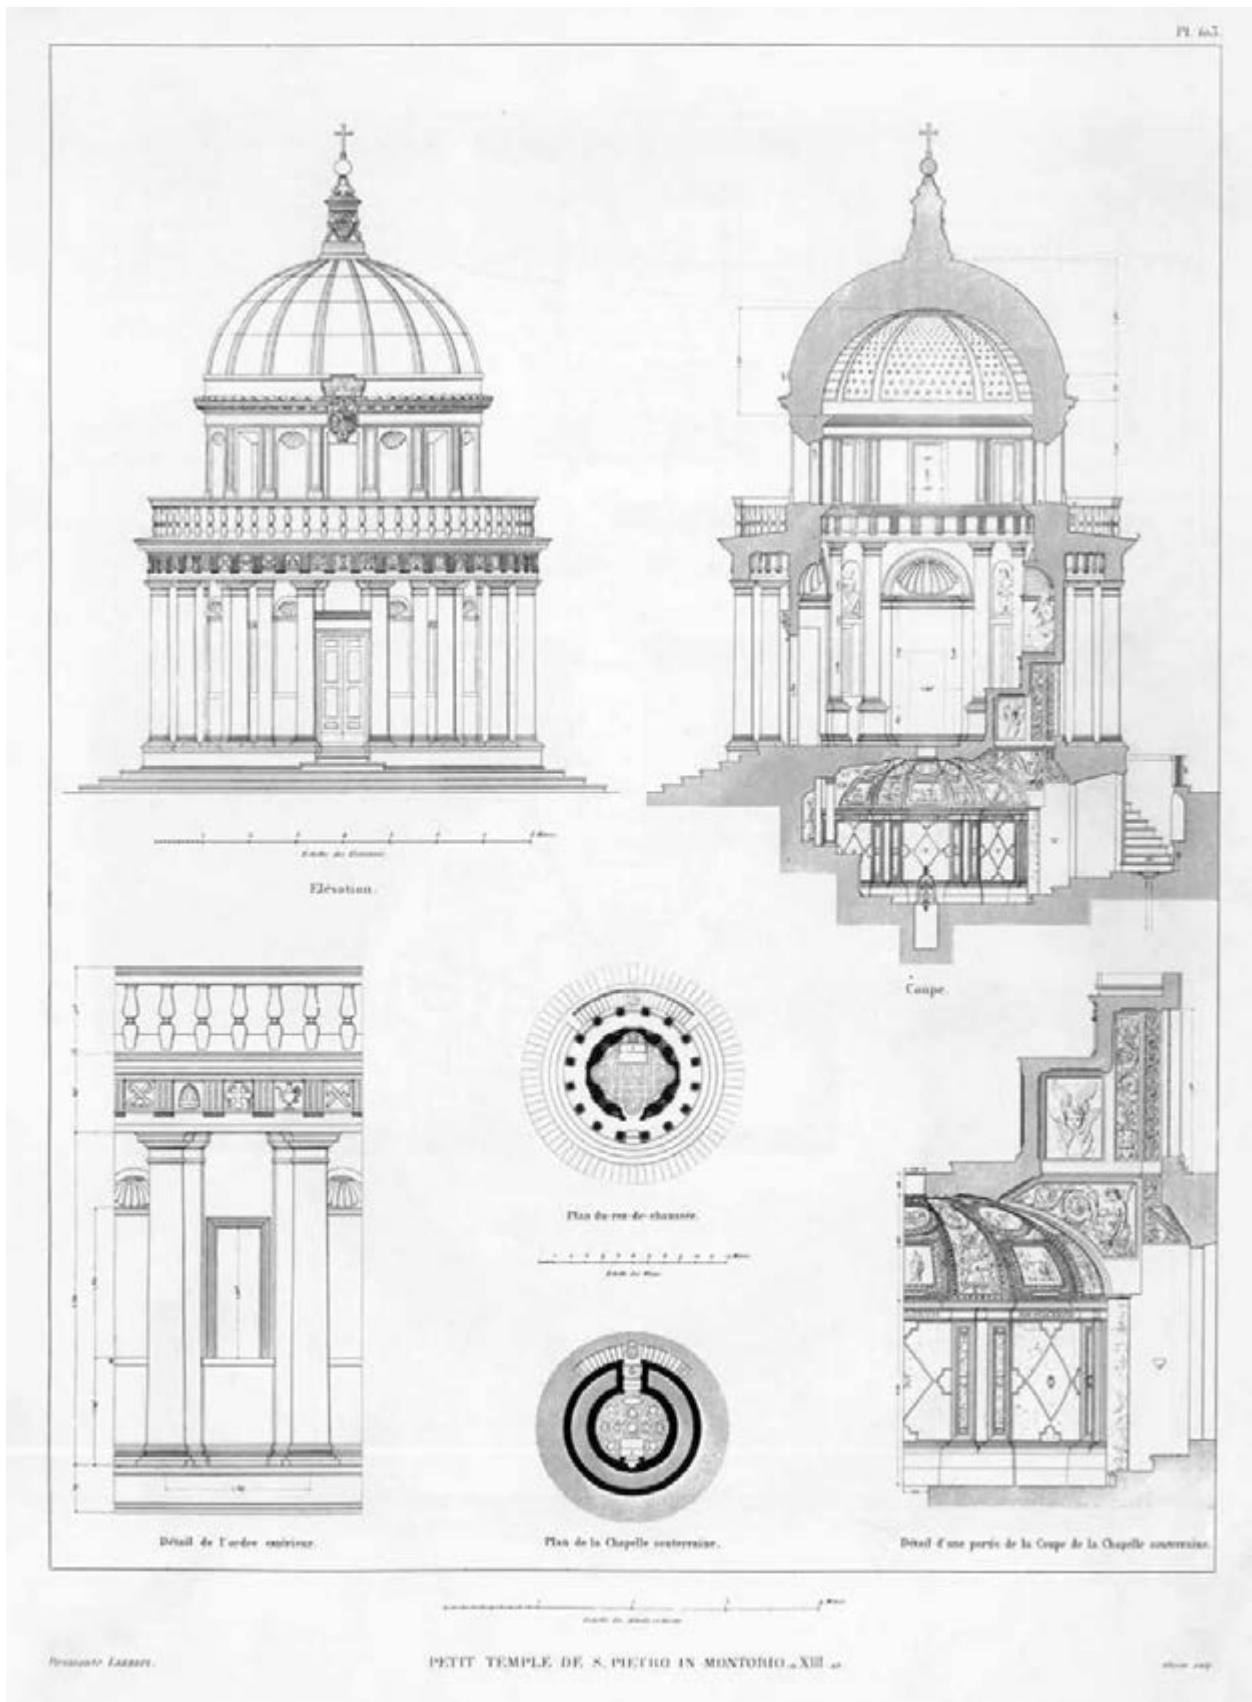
Paul Letarouilly, piante, prospetto, sezione e particolari del Tempietto (LETAROUILLY 1840, t. 1, tav. 103)
